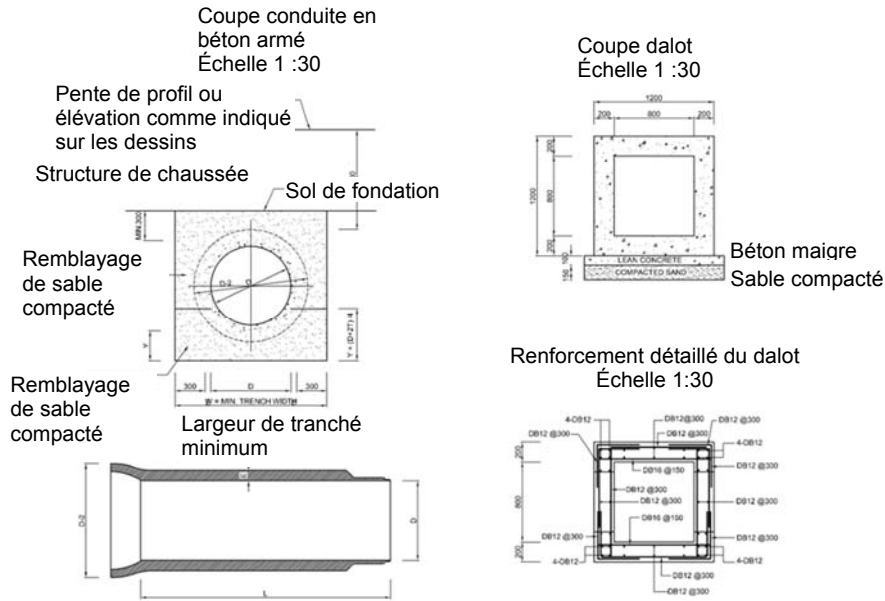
Profil type d'une buse tubulaire en béton armé et d'un dalot en béton armé
